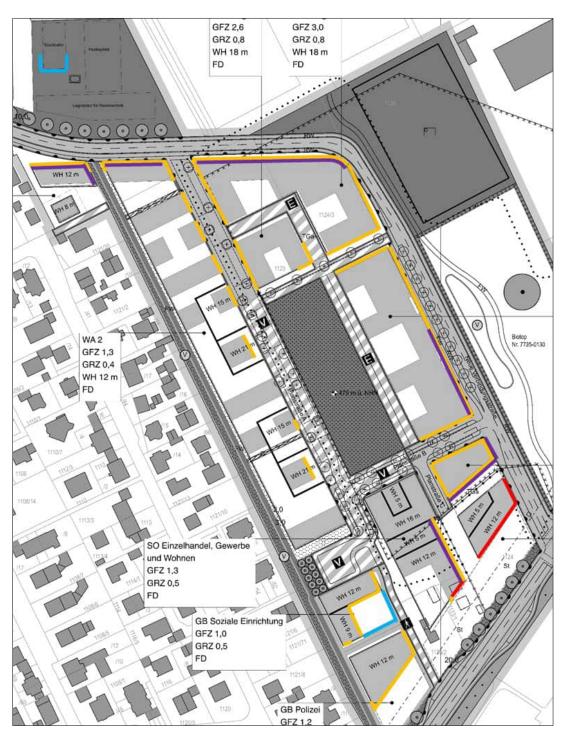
Fassadenkennzeichnung für die Vorschläge für Festsetzungen zum Bebauungsplan.
